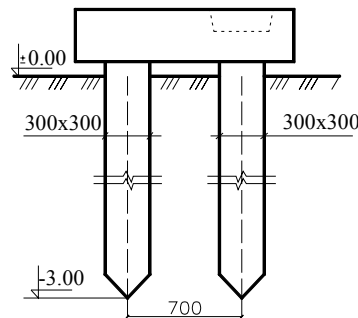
Фундамент з двома палями і збірним залізобетонним ростверком (Полтавський трест «Сільбуд»)
